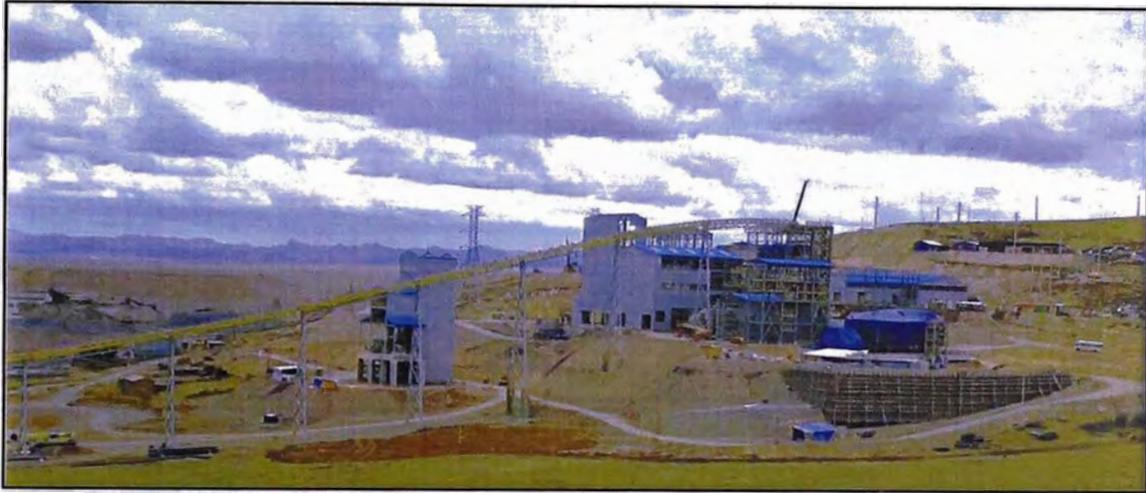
Vista panorámica del Chancado Secundario, Terciario y Planta de Lavado
